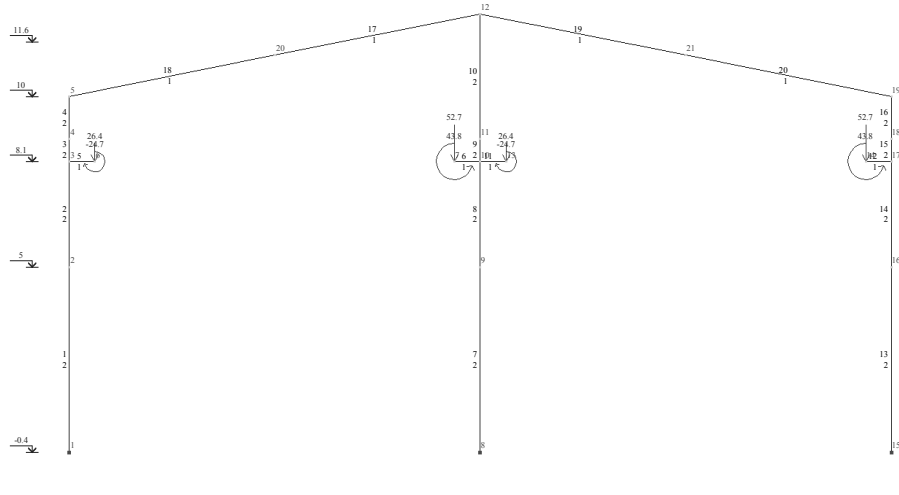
Схема нагружения поперечной рамой крановой нагрузкой (кран справа)
